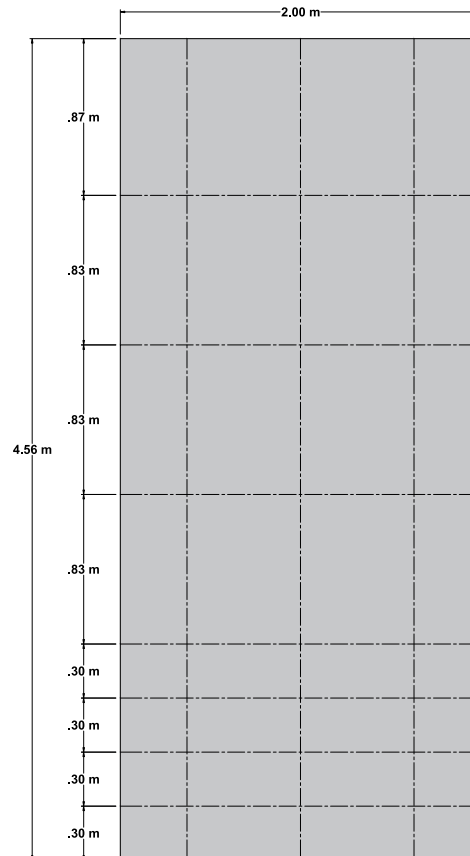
Detallado y refuerzo del espécimen WSH4. (Dazio et al.,2009).
